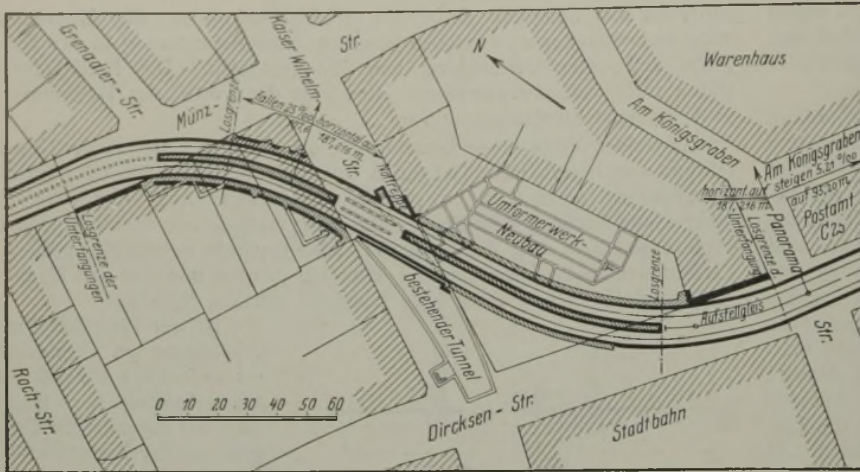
Lageplan der Baustelle Umformerwerk Alexanderplatz zu Berlin mit den drei Parallelmauern für den Untergrundbahntunnel im Los 21 der Schnellbahn Gesundbrunnen—Neukölln.
